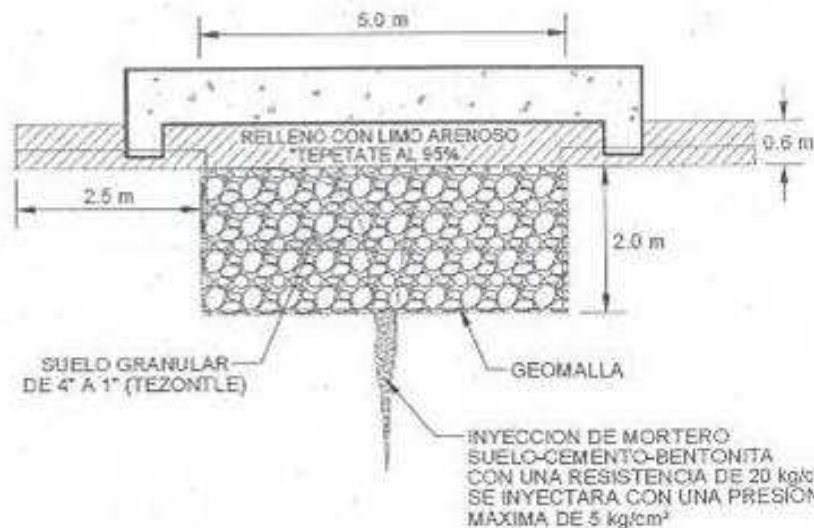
Recomendaciones para construir sobre grietas.
